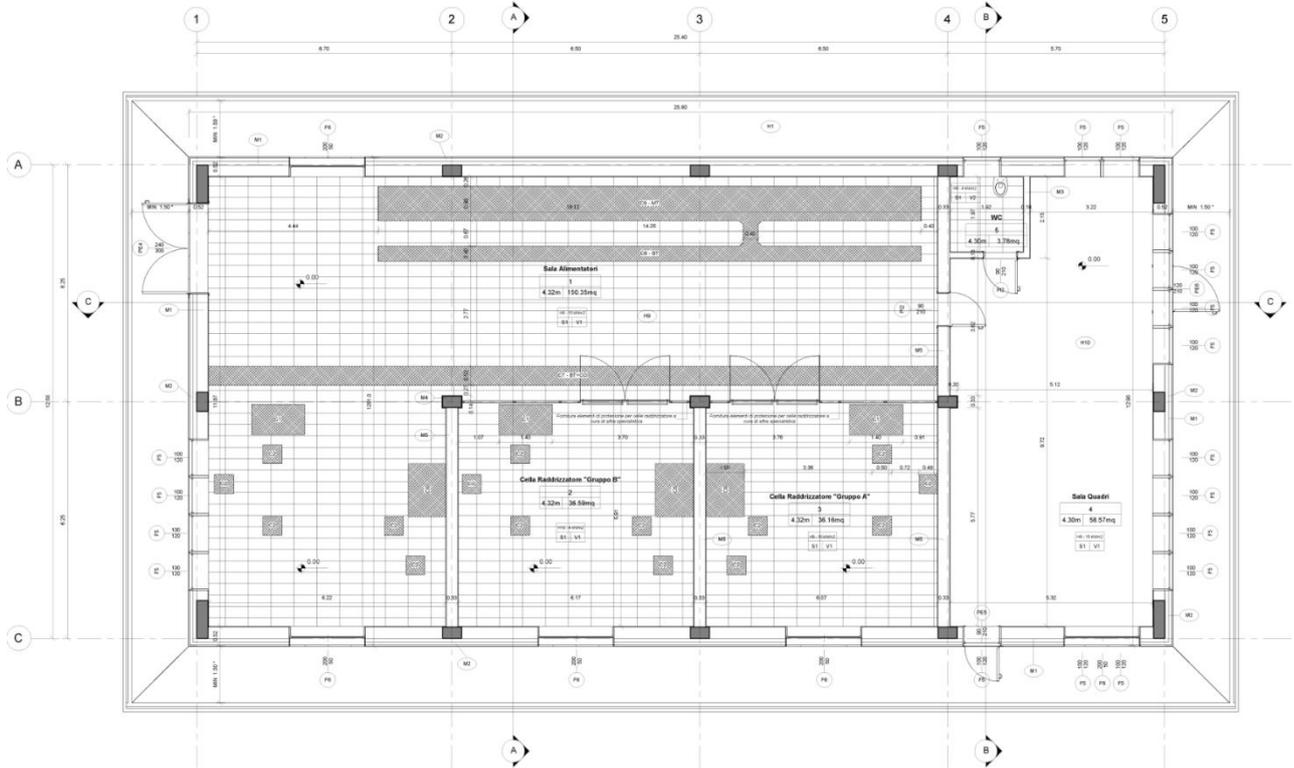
SSE Pieve Emanuele – Pianta Architettonica Piano Terra
